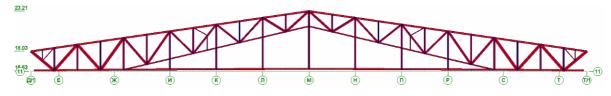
Конструктивная схема несущих конструкций покрытия ледового дворца на 7000 мест в г. Бобруйске
